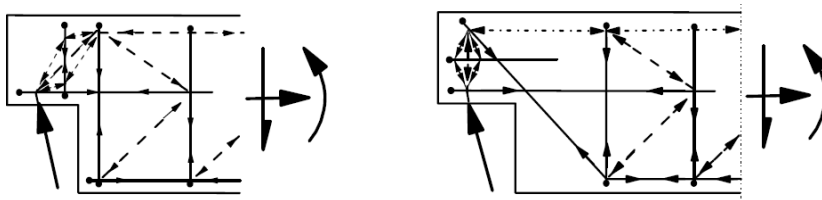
Beispiele für Stabwerkmodelle für ausgeklinkte Auflager
